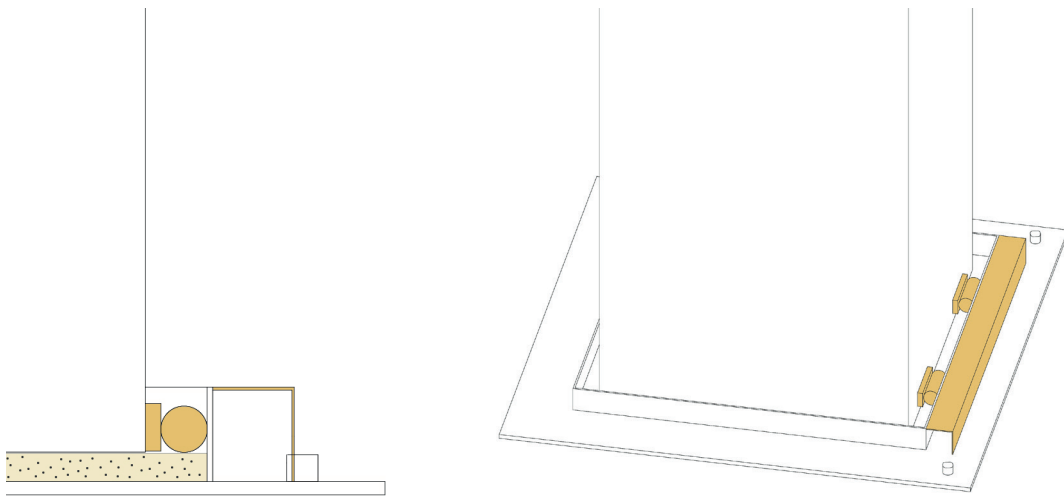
Dispositif de reprise de l'effort horizontal en pied de portique, sur la dalle d'essai
